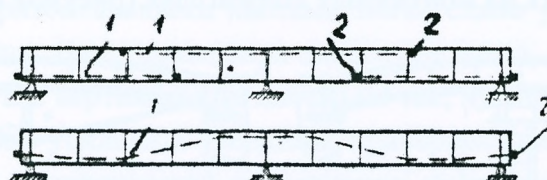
Схемы расположения гибких шпренгелей на неразрезных фермах: 1 – кабель; 2 – анкер.
